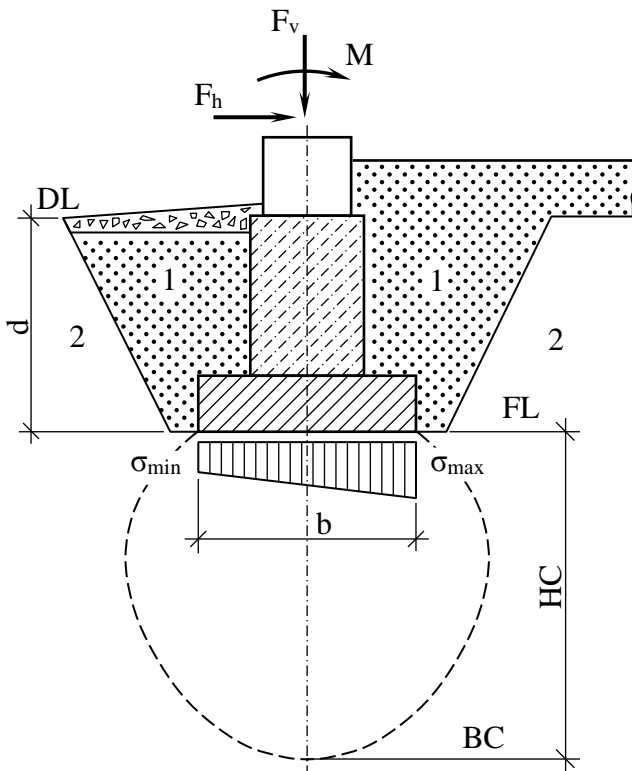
Схема взаємодії фундаменту, який споруджується у відкритому котловані, з навколишнім ґрунтом:
